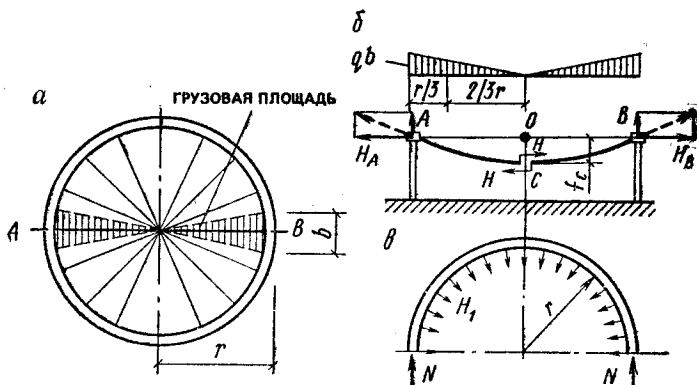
К расчету висячего покрытия, круглого в плане, с радиальным расположением вант
